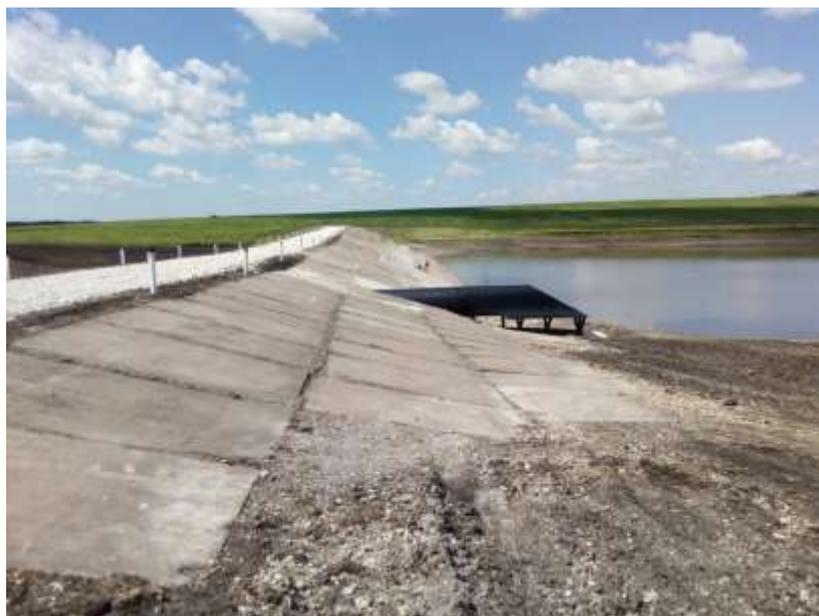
Земляная плотина, укрепленная бетонными плитами.
